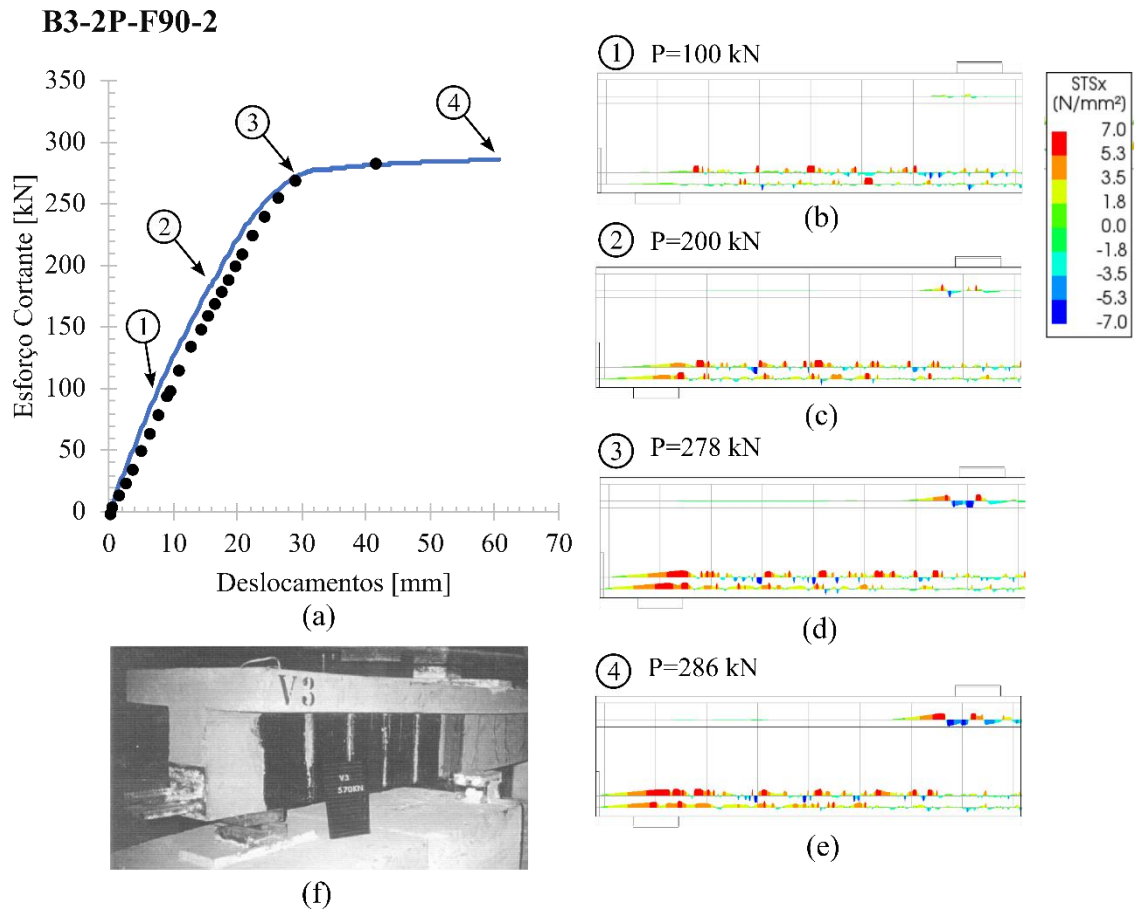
Tensões de aderência entre armaduras longitudinais e concreto para a viga B3-2P-F90-2.
